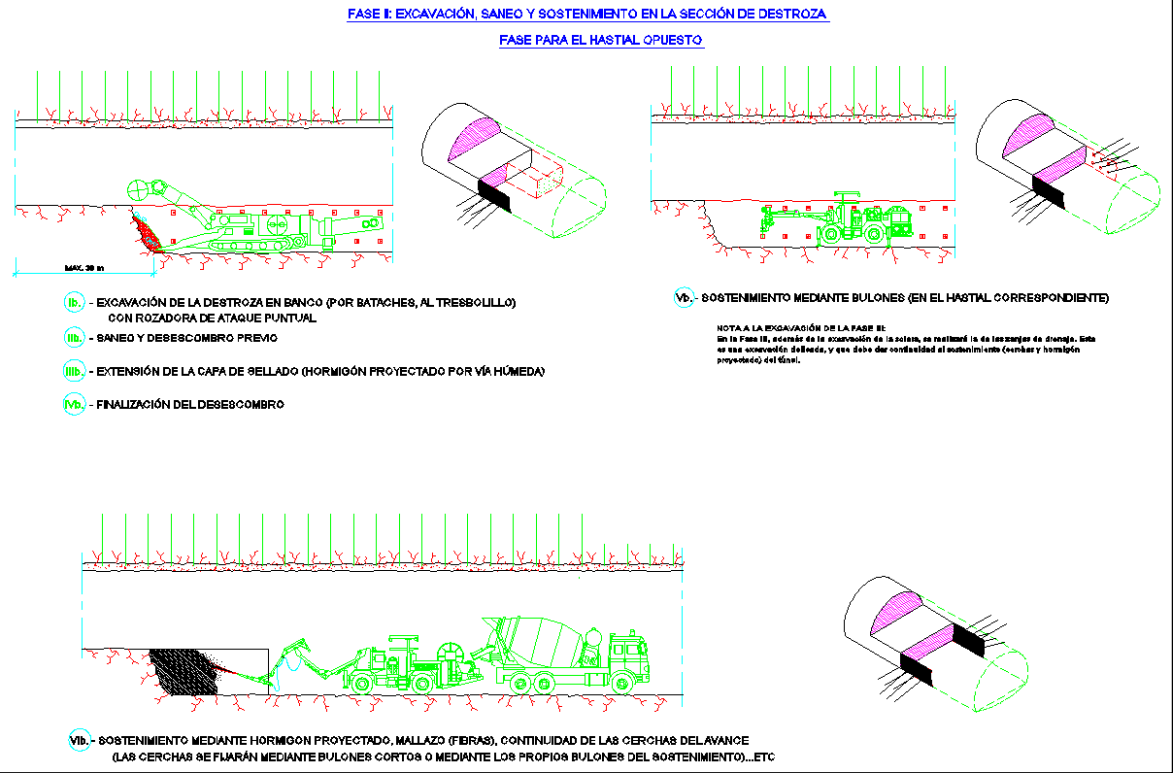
Fase de excavación en la sección de Destroza, hastial opuesto
